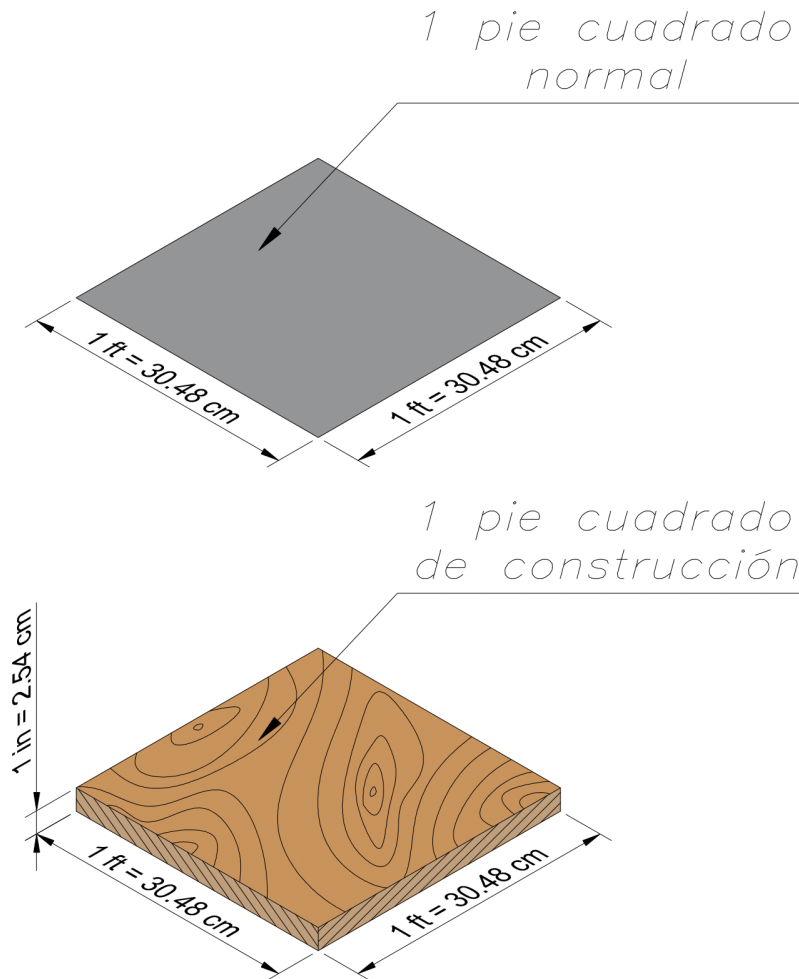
Vista Isométrica de un Pie Cuadrado de Construcción.
